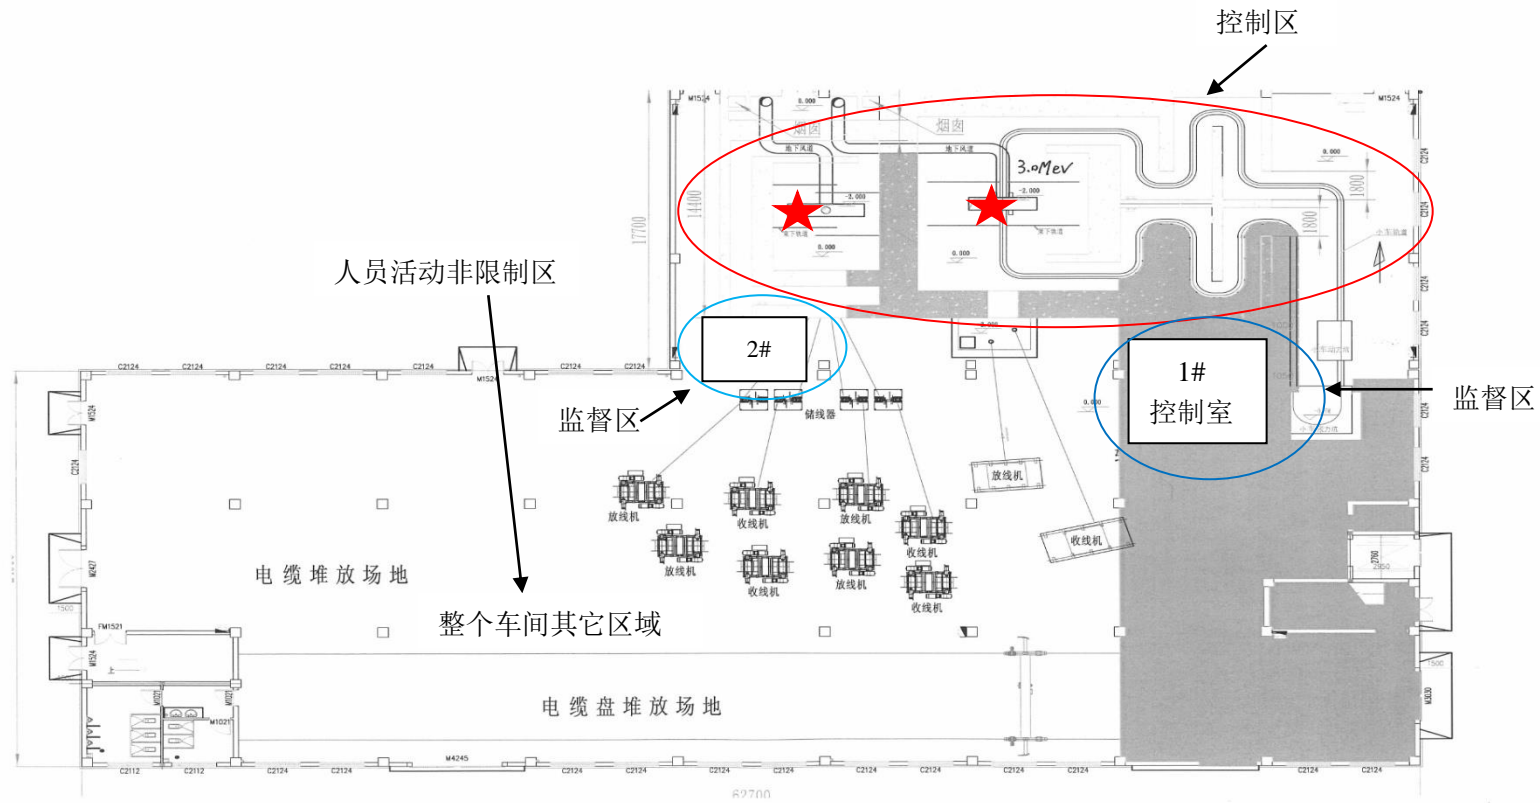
乐清市华仪电缆附件有限公司辐照加工车间平面布置示意图
